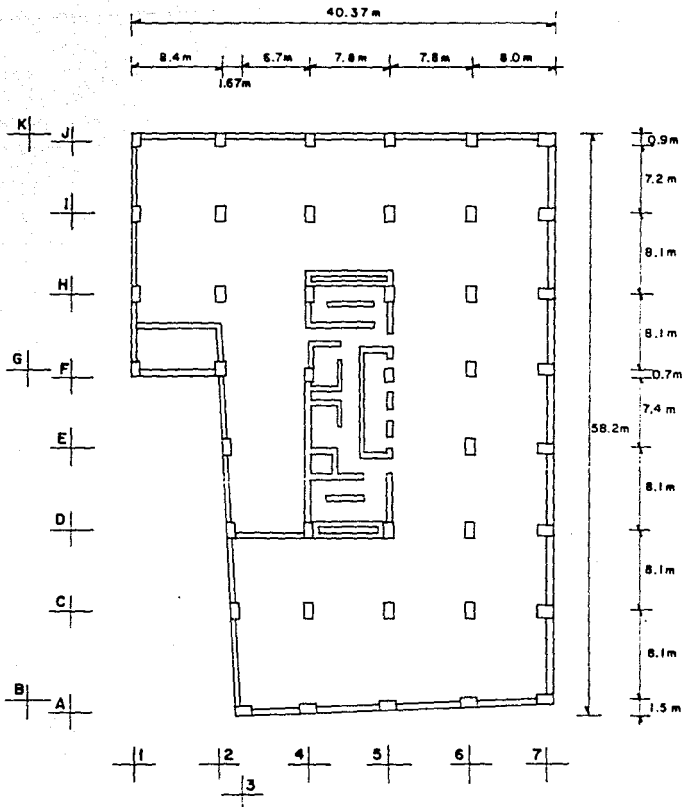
PLANTA TIPO NIVEL 4 di 7
